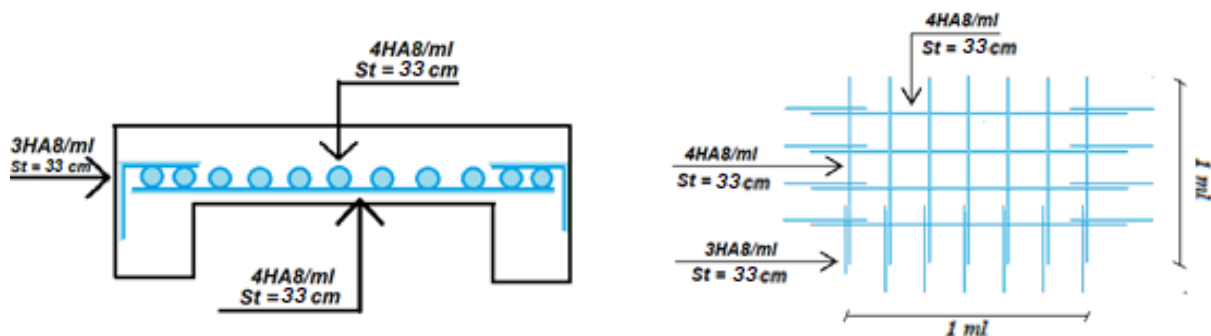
Schéma de ferrailages de la dalle plain D1
